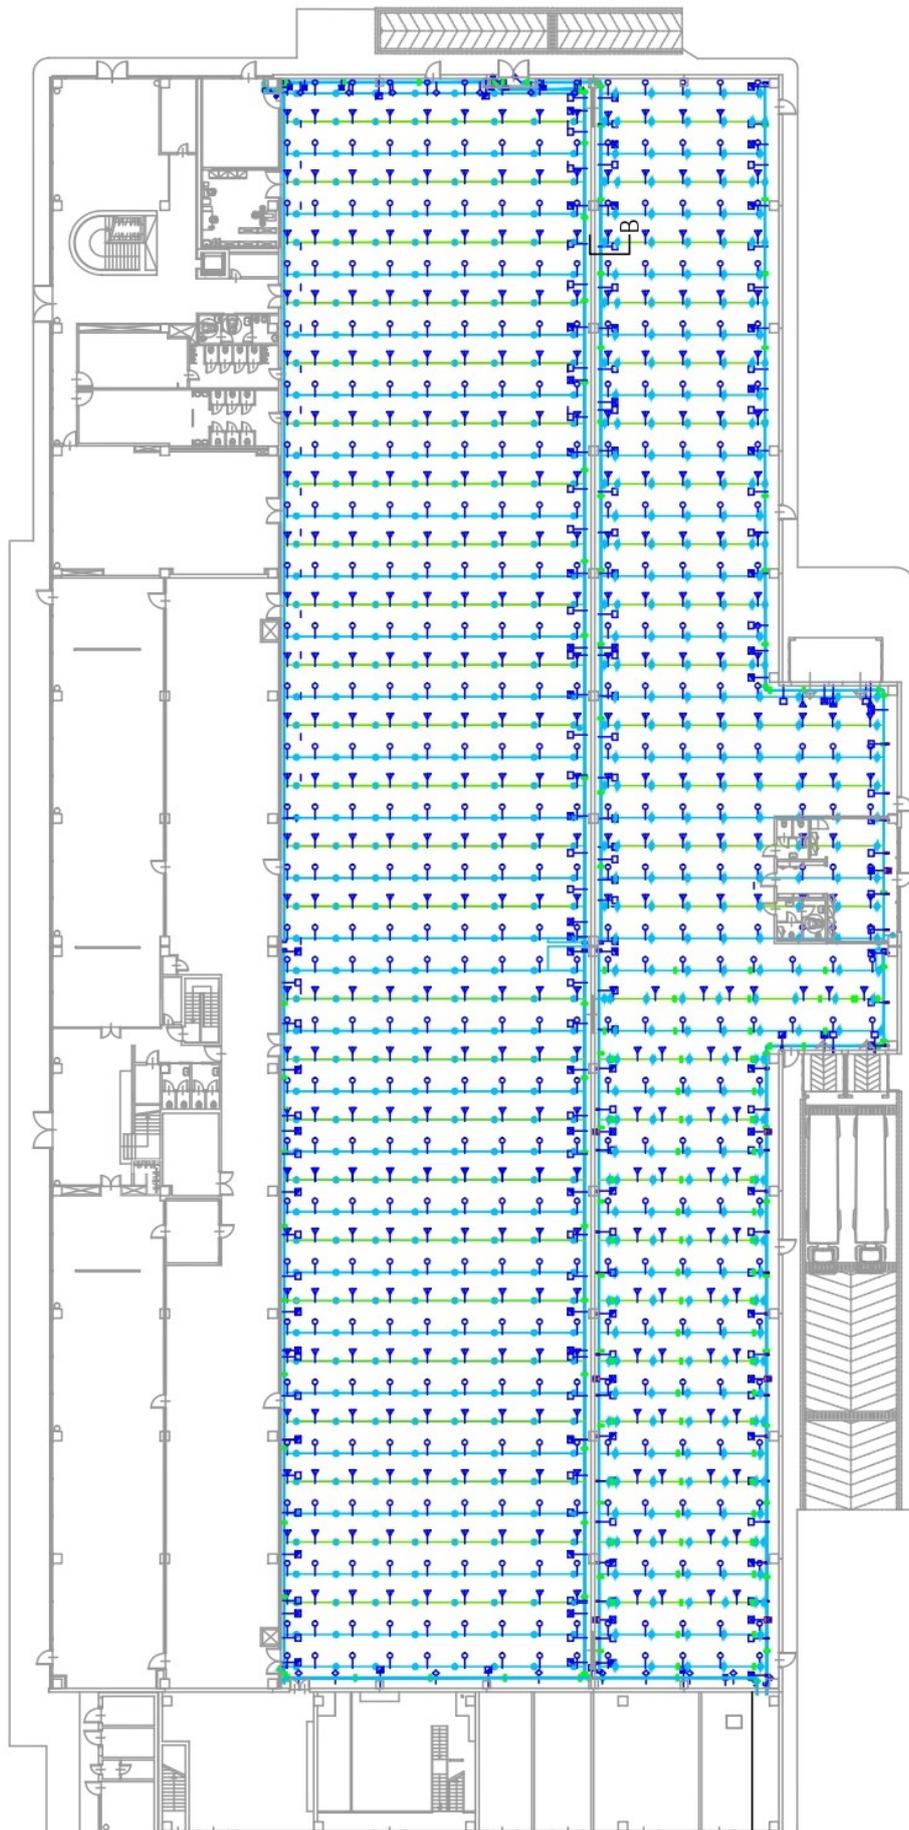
Planimetria sprinkler piano terra magazzino - laboratorio
